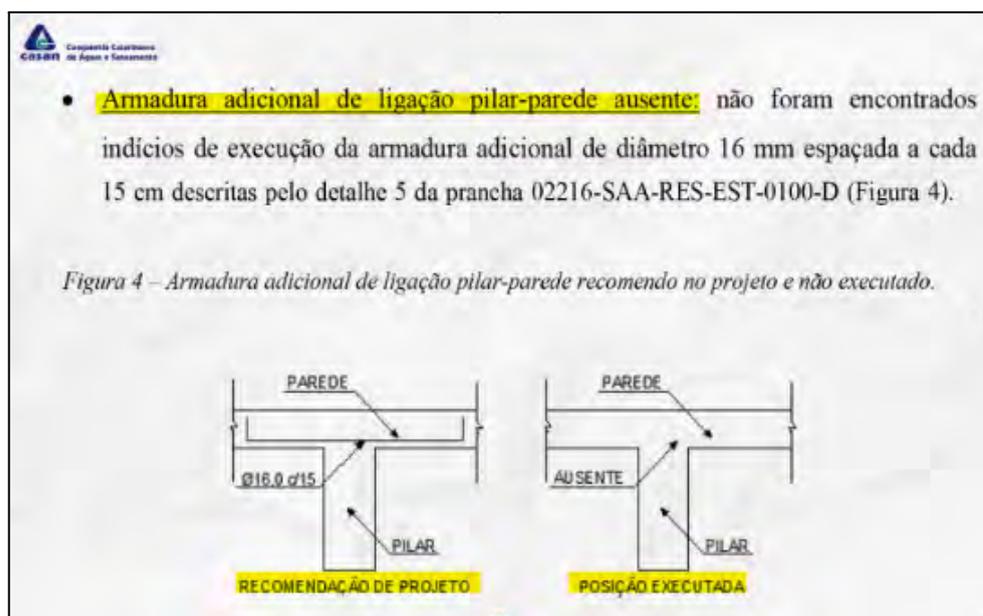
Divergência 3: ausência de armadura de 16 mm entre pilares e paredes ([anexo](#))
